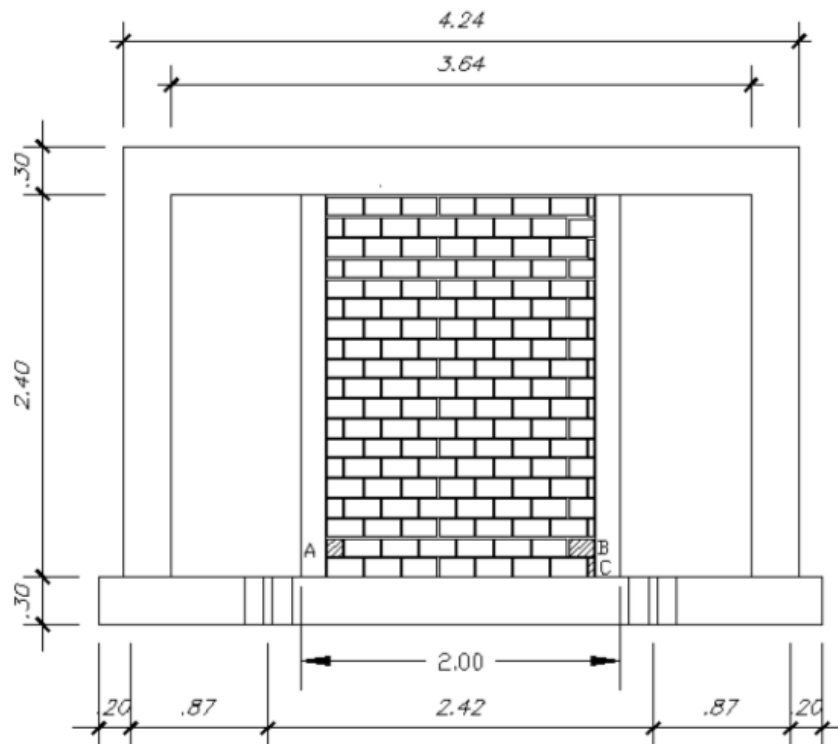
Pórtico con columnetas y con tabique arriostrado en su Interior para Ensayo de Cargas Perpendiculares al Plano
